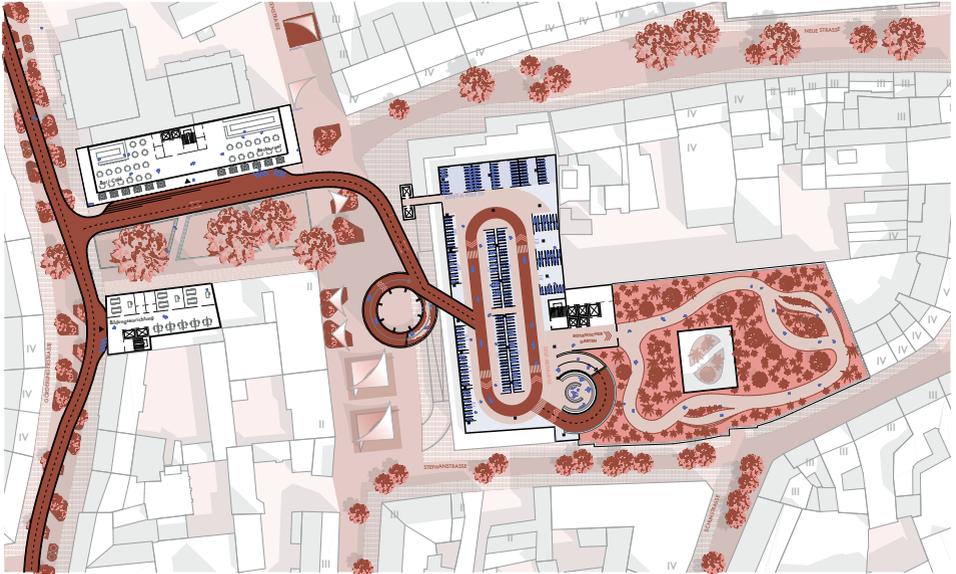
Grundriss städtebauliches Detail 5. OC
